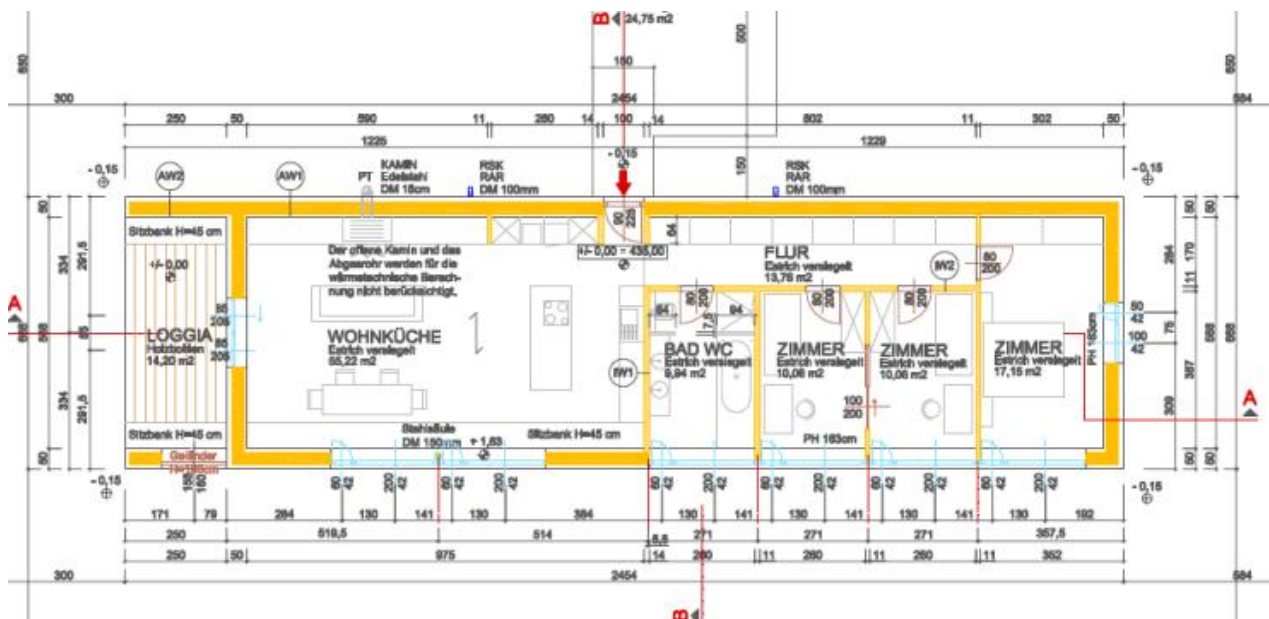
Grundriss Modellgebäude in leichter Bauform (Riegelwände) jedoch mit minimalen Fensterflächen
